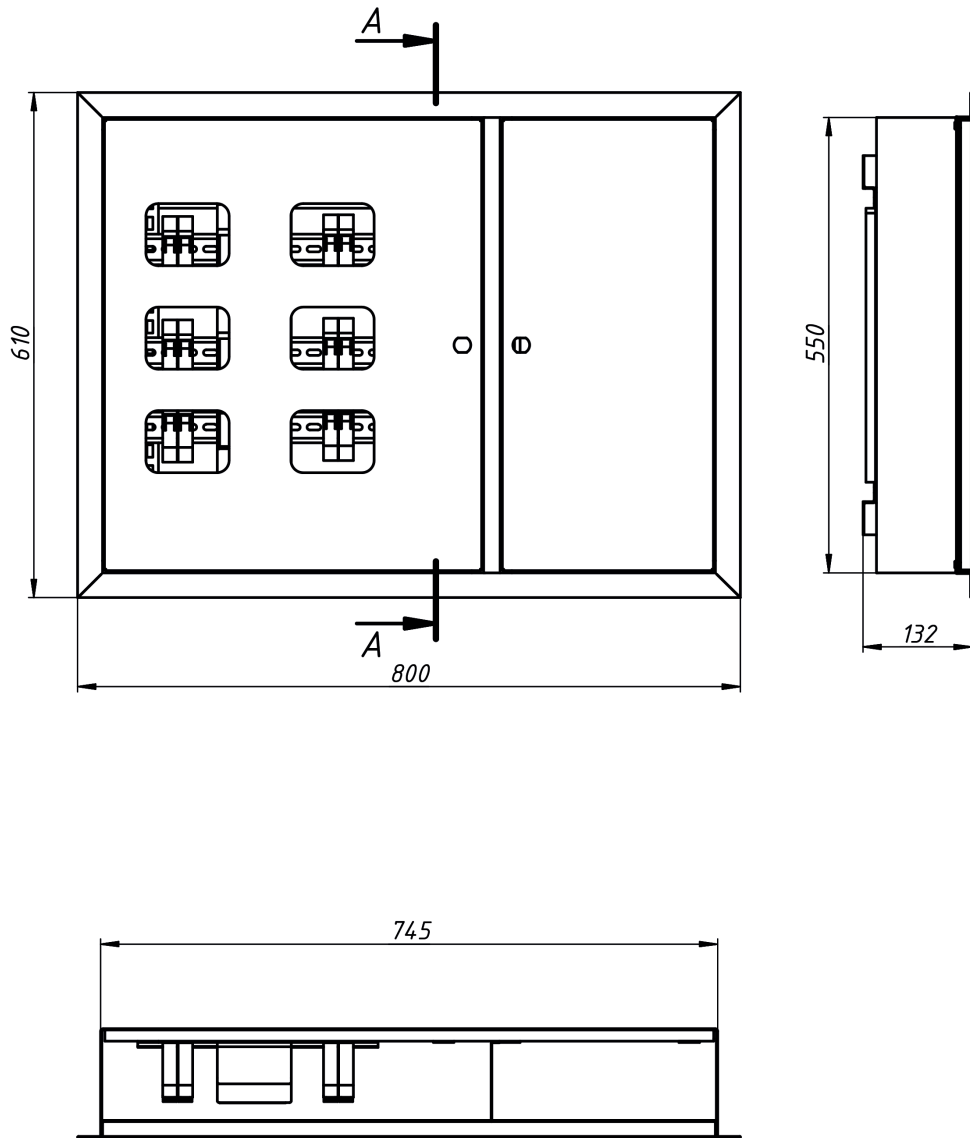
Габаритные размеры ЩЭ-РЭС
